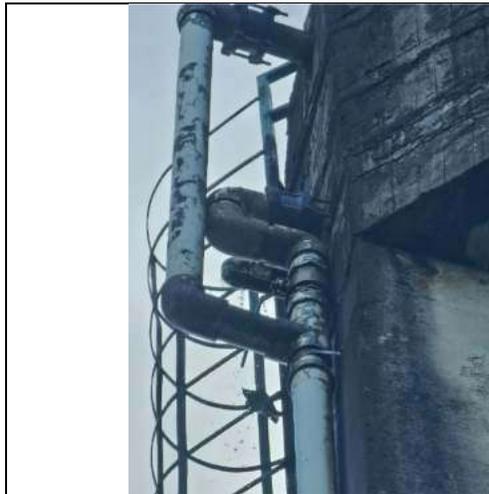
Accesorios tubería de ingreso tanque Canangucho.
